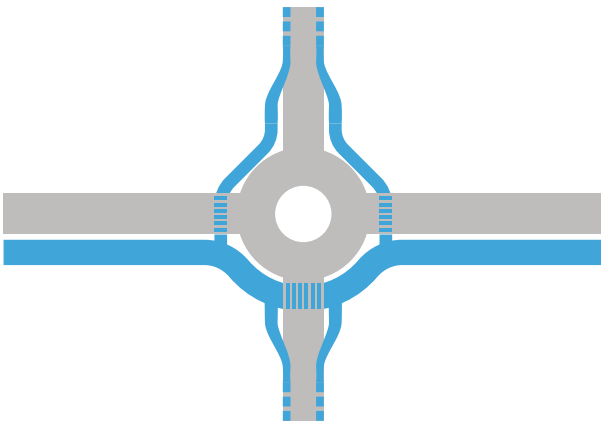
4-Arm-Kreiseln mit Zweirichtungsradschwergang in der Hauptfahrrichtung und Anschlussmöglichkeiten der Nebenstraßen
